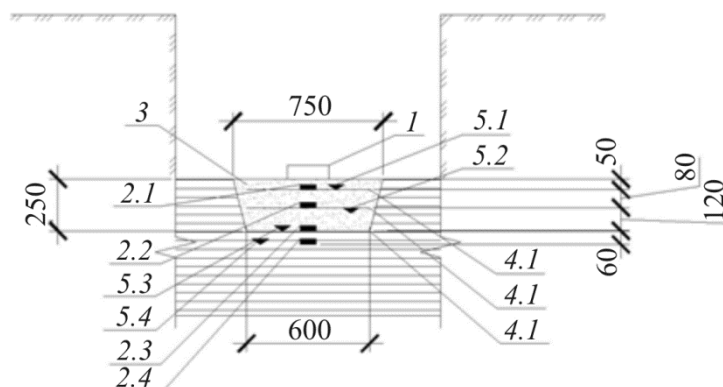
Схема испытаний № 2. Подушка, армированная георешеткой: 1 – жесткий штамп; 2 – грунтовые месдозы (2.1–2.4 – номера месдоз); 3 – фундаментная подушка; 4 – георешетка; 5 – грунтовые марки (5.1–5.4 – номера марок)
